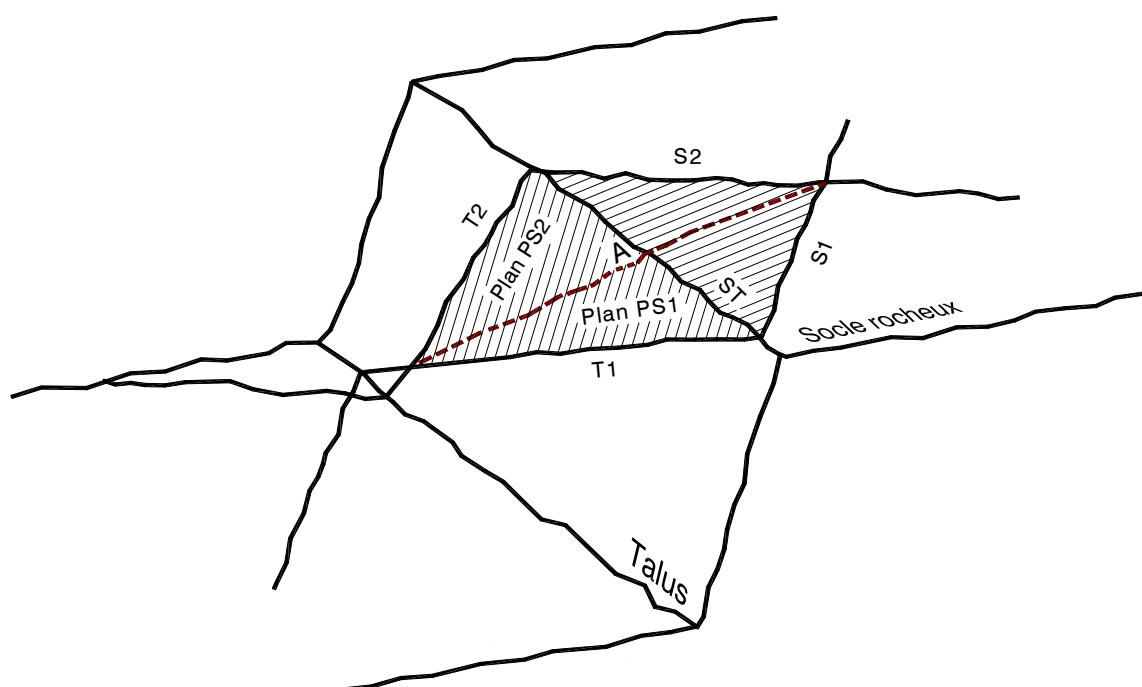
Tétraèdre complètement exposé découpé par deux plans structuraux qui se rencontrent à proximité d'un talus. La ligne A est l'intersection des plans structuraux PS1 et PS2, la ligne ST est l'intersection du plan du talus avec le plan de la surface du socle rocheux, les lignes T1 et T2 sont les intersections du plan du talus avec les plans structuraux PS1 et PS2 respectivement, les lignes S1 et S2 sont les intersections du plan de la surface du socle rocheux avec les plans structuraux PS1 et PS2 respectivement.
